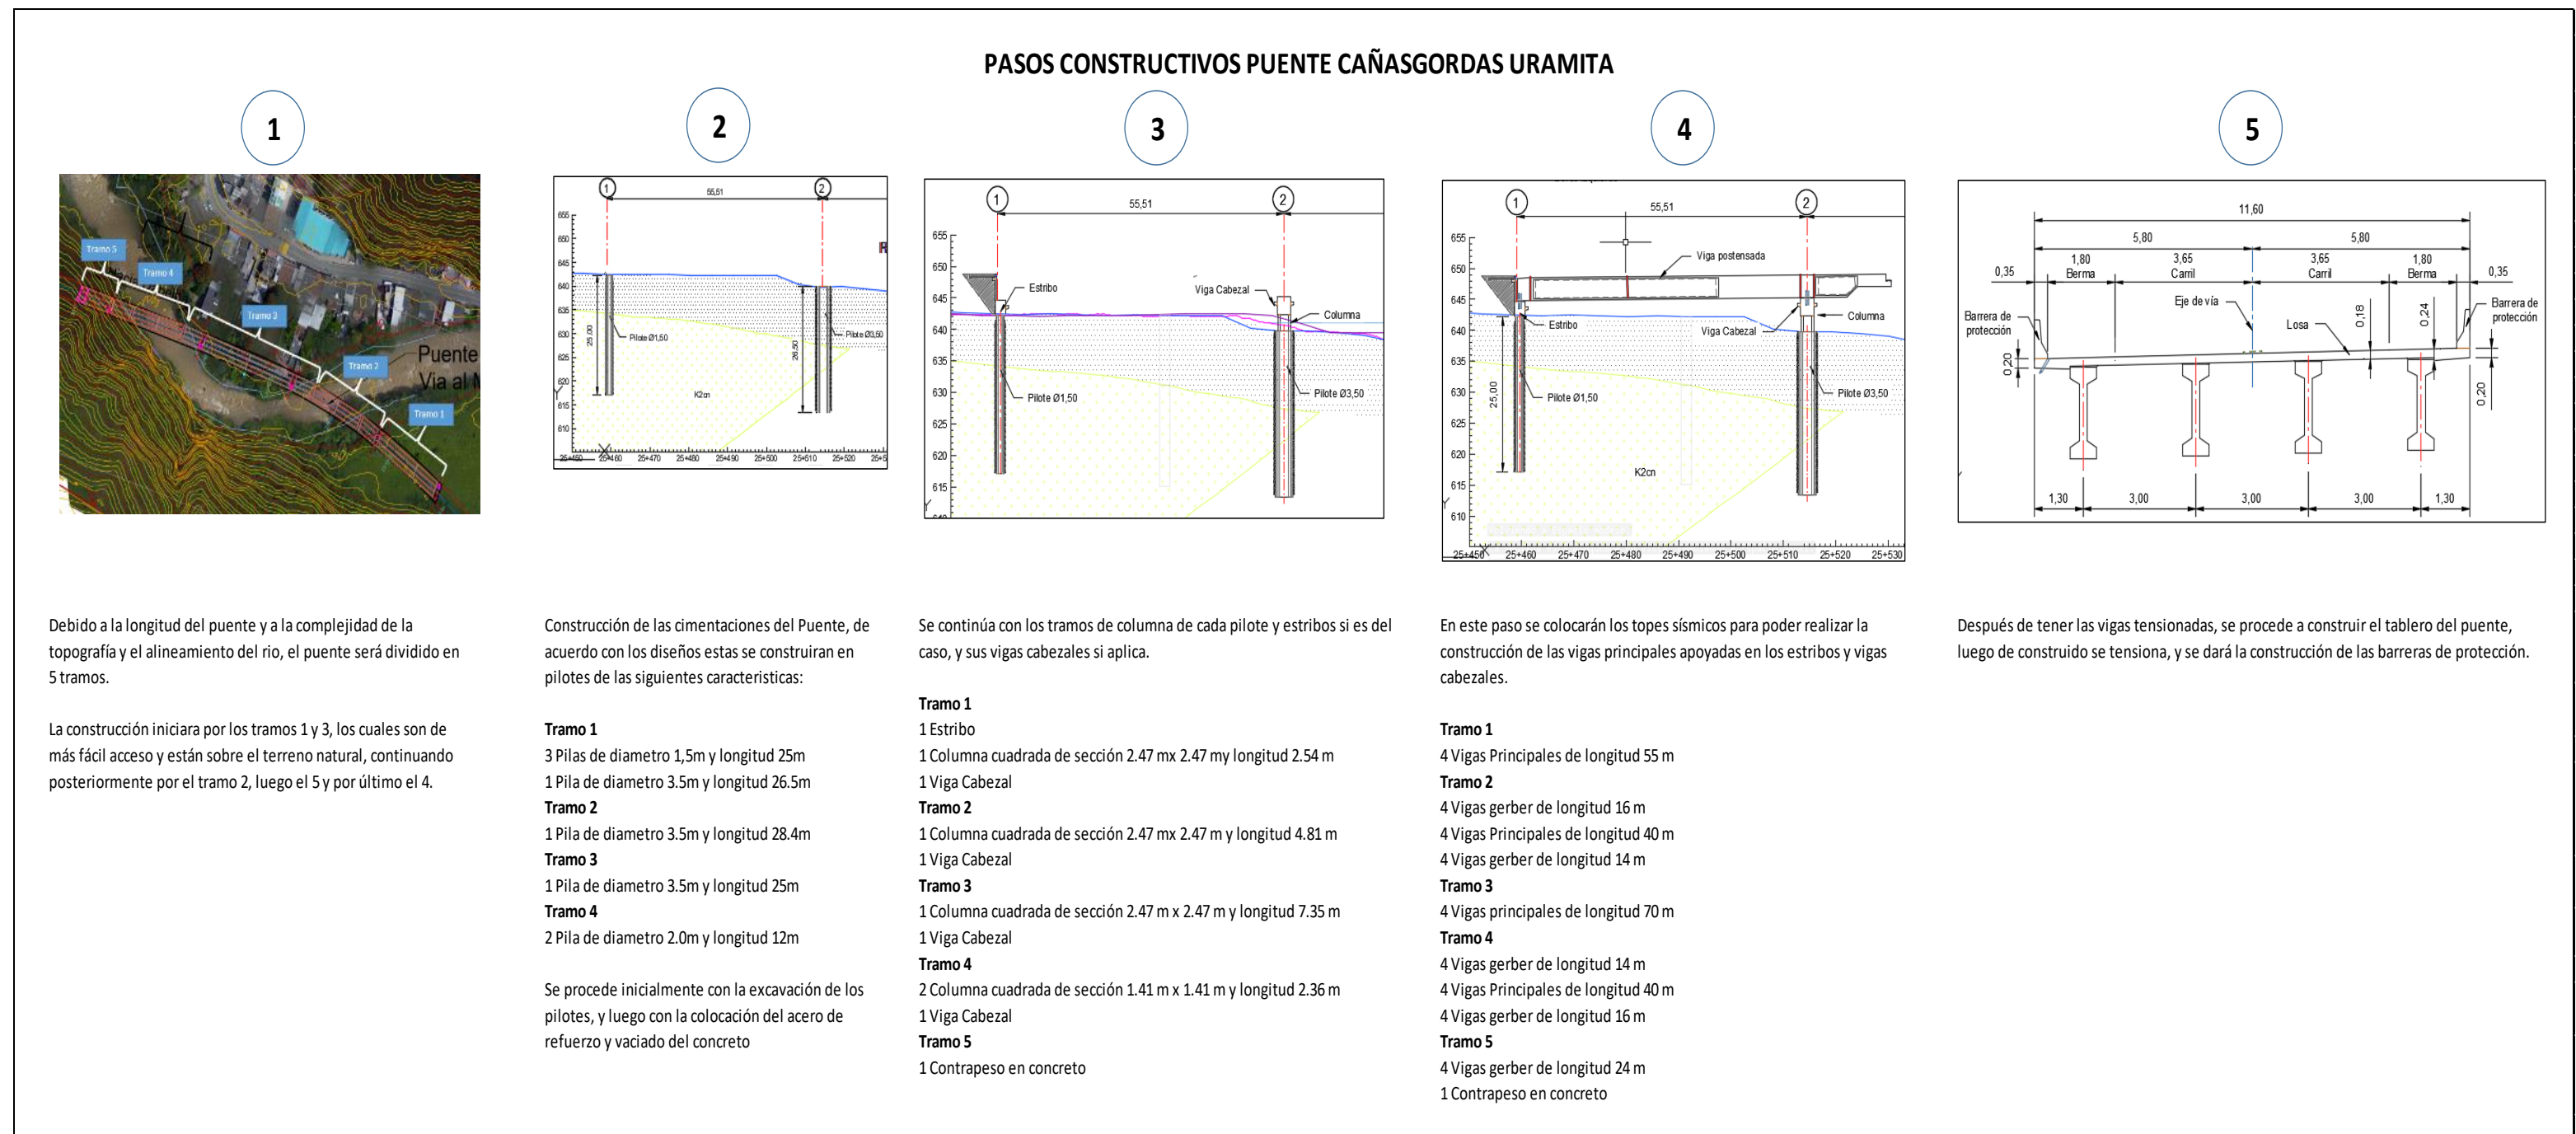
Proceso Constructivo Puente Cañasgordas Uramita
